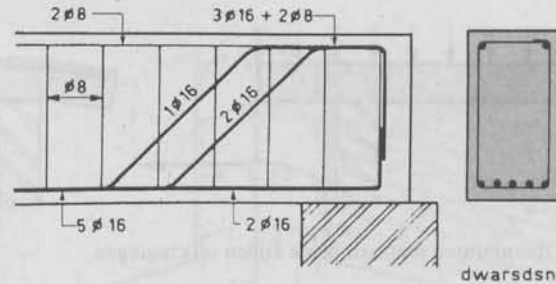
Voorbeeld van de wapening van een gewapend-betonbalk
